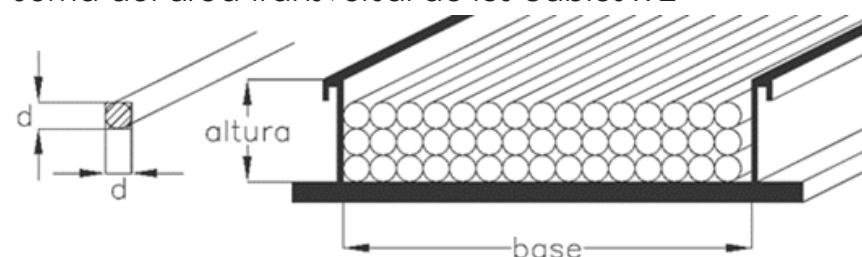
Ejemplo de la ocupación del área transversal interna de una bandeja portacables al conducir cables de telecomunicaciones en ellos. Fuente: Propia.
